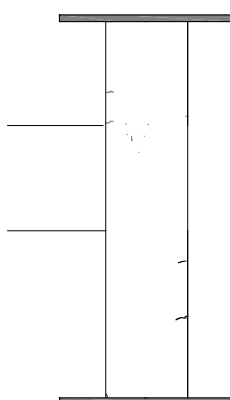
(a) ひび割れ状況（試験体 F1）
